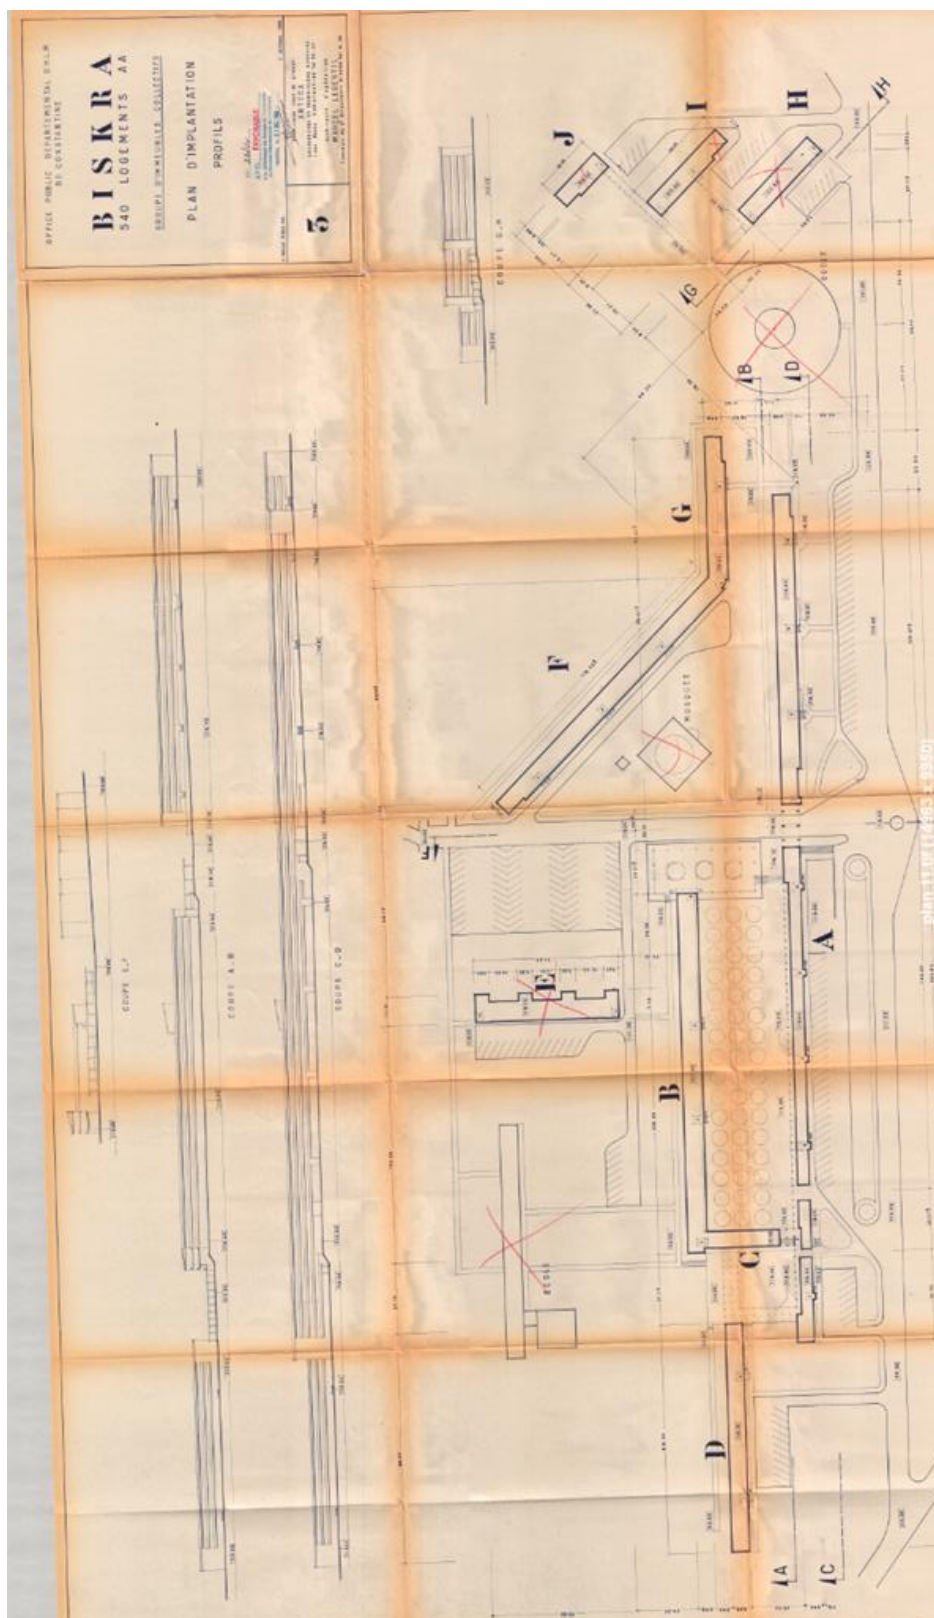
9 Plan d'implantation des blocs barre, Source APC Biskra
